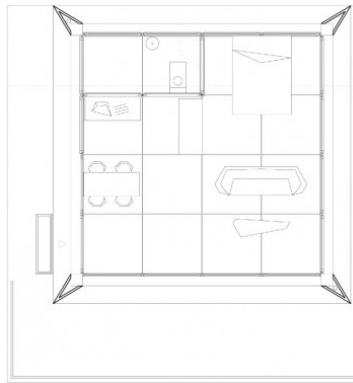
Exemplo de uma planta onde são visíveis as calhas metálicas no piso
